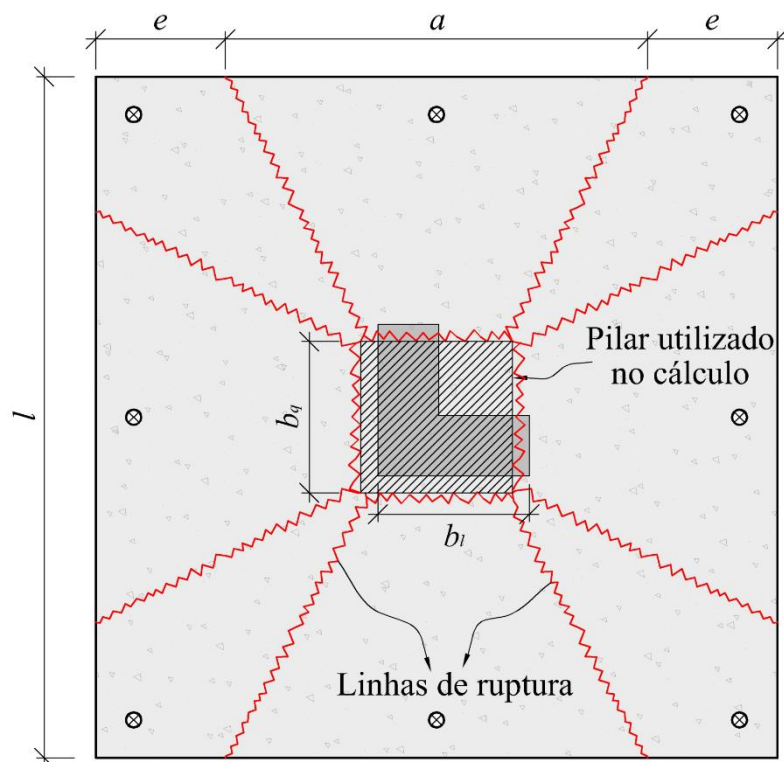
Configuração de ruína por flexão para as lajes apoiadas sobre pilares de secção em “L”
